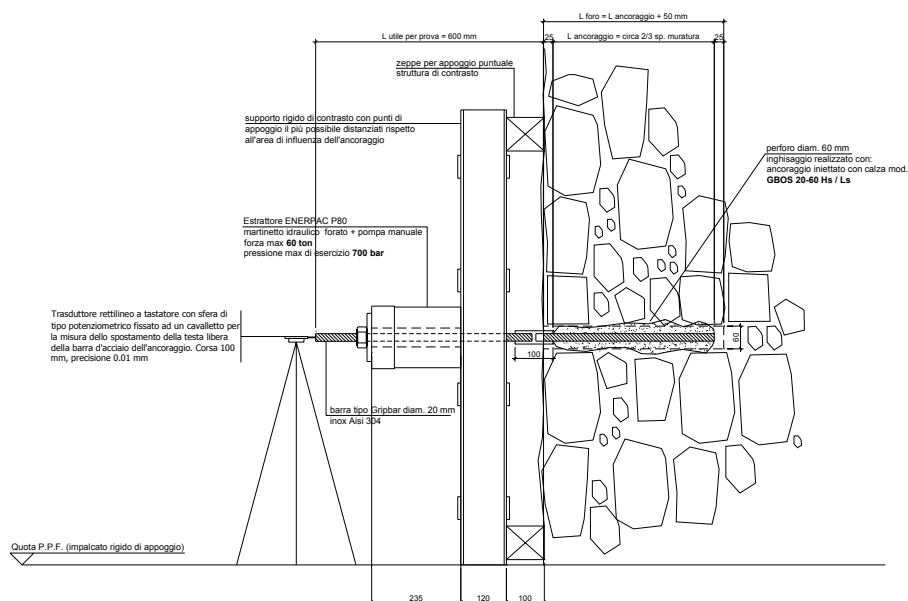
Layout delle prove d'estrazione su ancoraggi iniettati con calza
